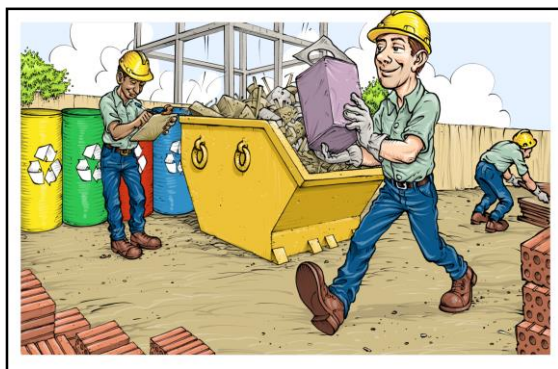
Canteiro de obras com resíduo separado corretamente. (Ilustração: Elias Silveira)
